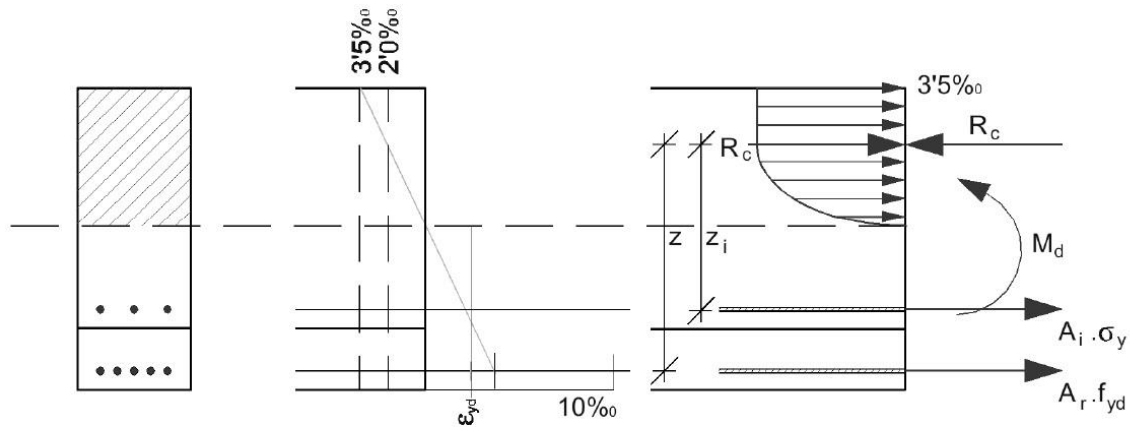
Cálculo del refuerzo de vigas a flexión con hormigón armado. Fuerzas y deformaciones en el hormigón y el acero. Diagrama Parábola rectángulo
